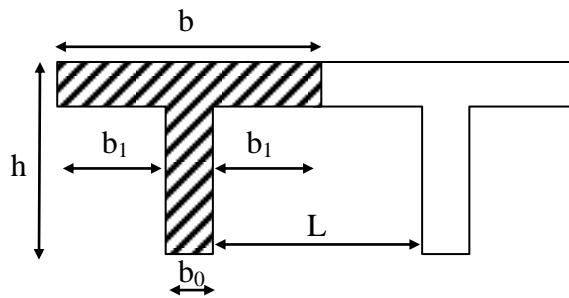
Section de calcul de la poutrelle après Coulage de la dalle de compression
